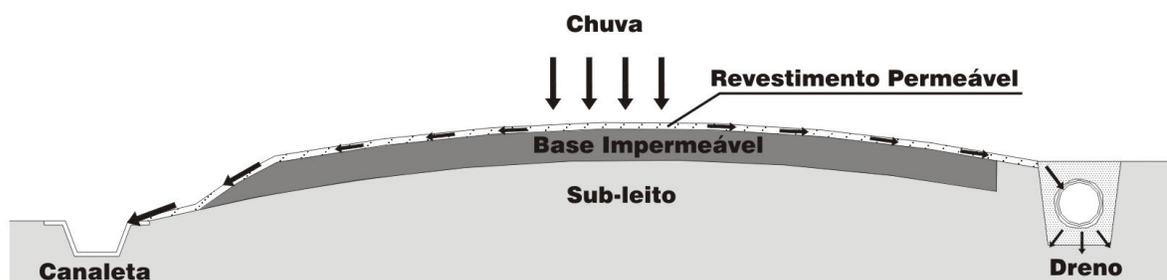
Em alguns tipos de pavimento em que se utiliza revestimento permeável, a água não é infiltrada no sub-leito.
